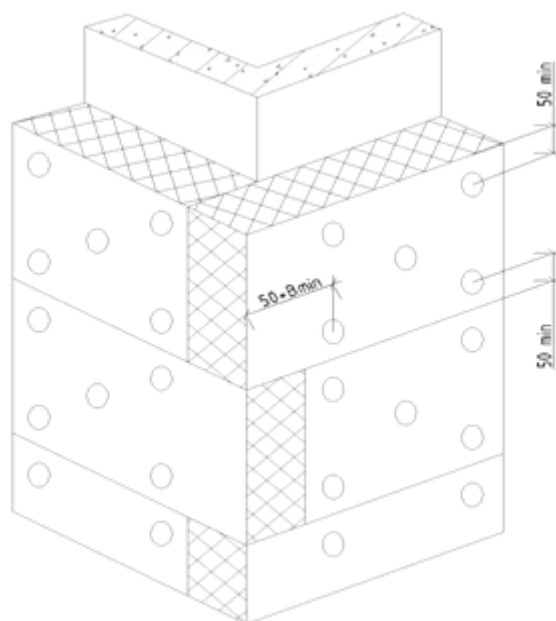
Монтаж плит теплоизоляции на углу здания
